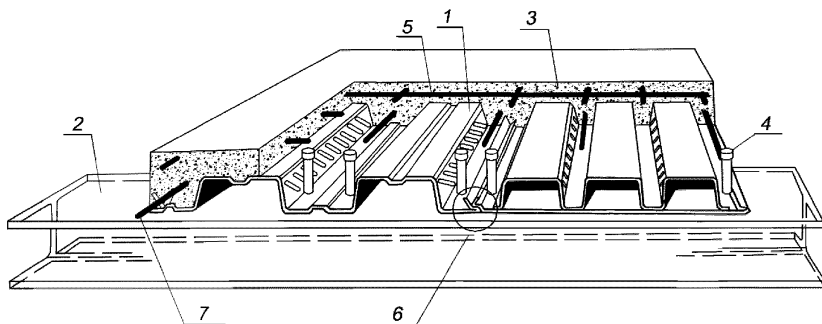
Конструкция сталежелезобетонной плиты, армированная профилированным настилом:
